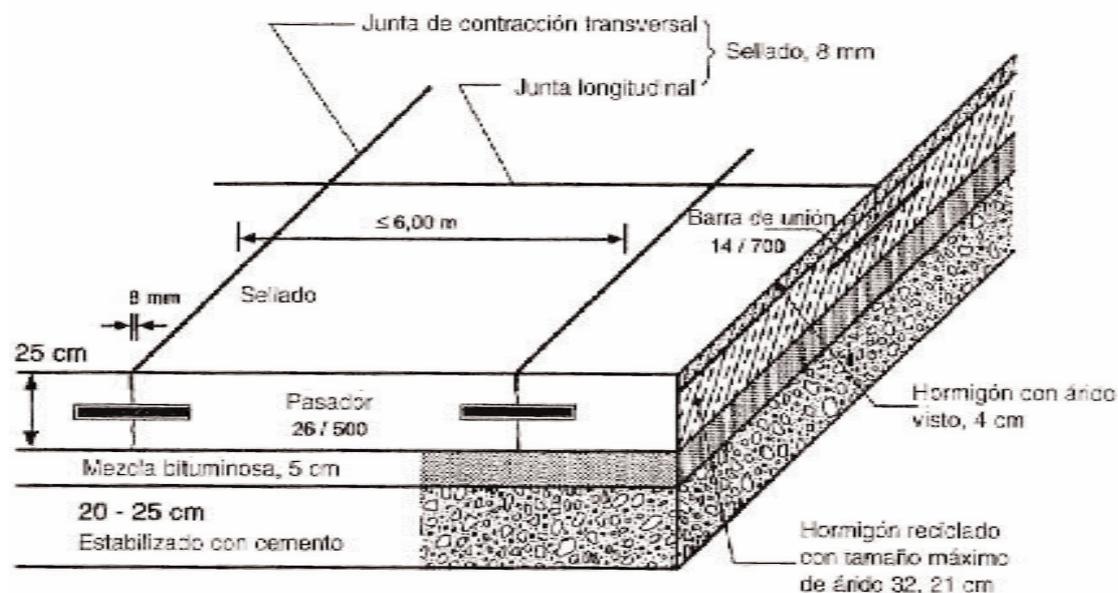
Esquema de sección transversal de un firme con pavimento de hormigón ejecutado mediante la técnica bicapa
